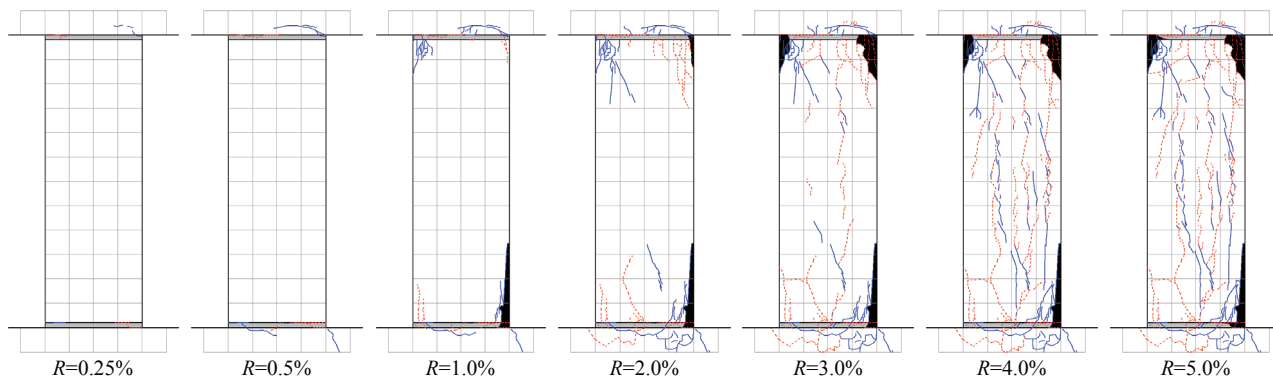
U1/3-0.2 ひび割れ状況
